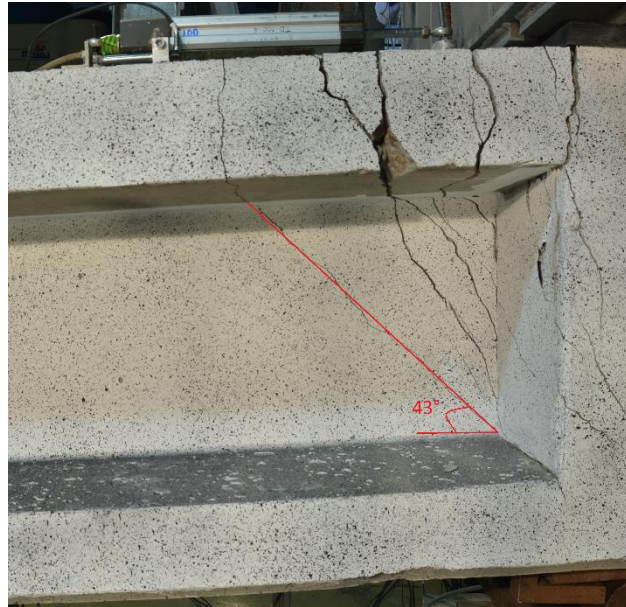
Ángulo de fisuración en la viga 5
